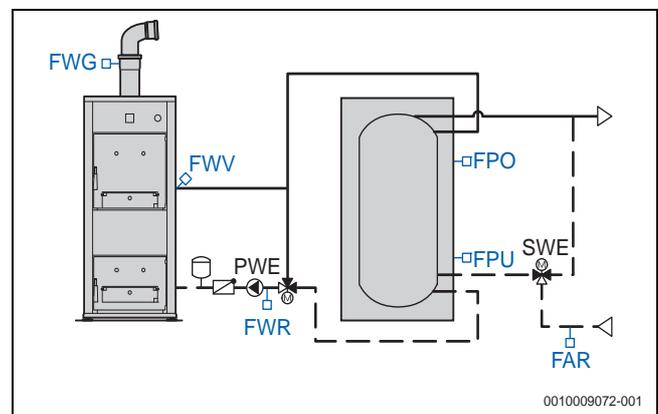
Manuelle Wärmeerzeuger – Start von Hand
